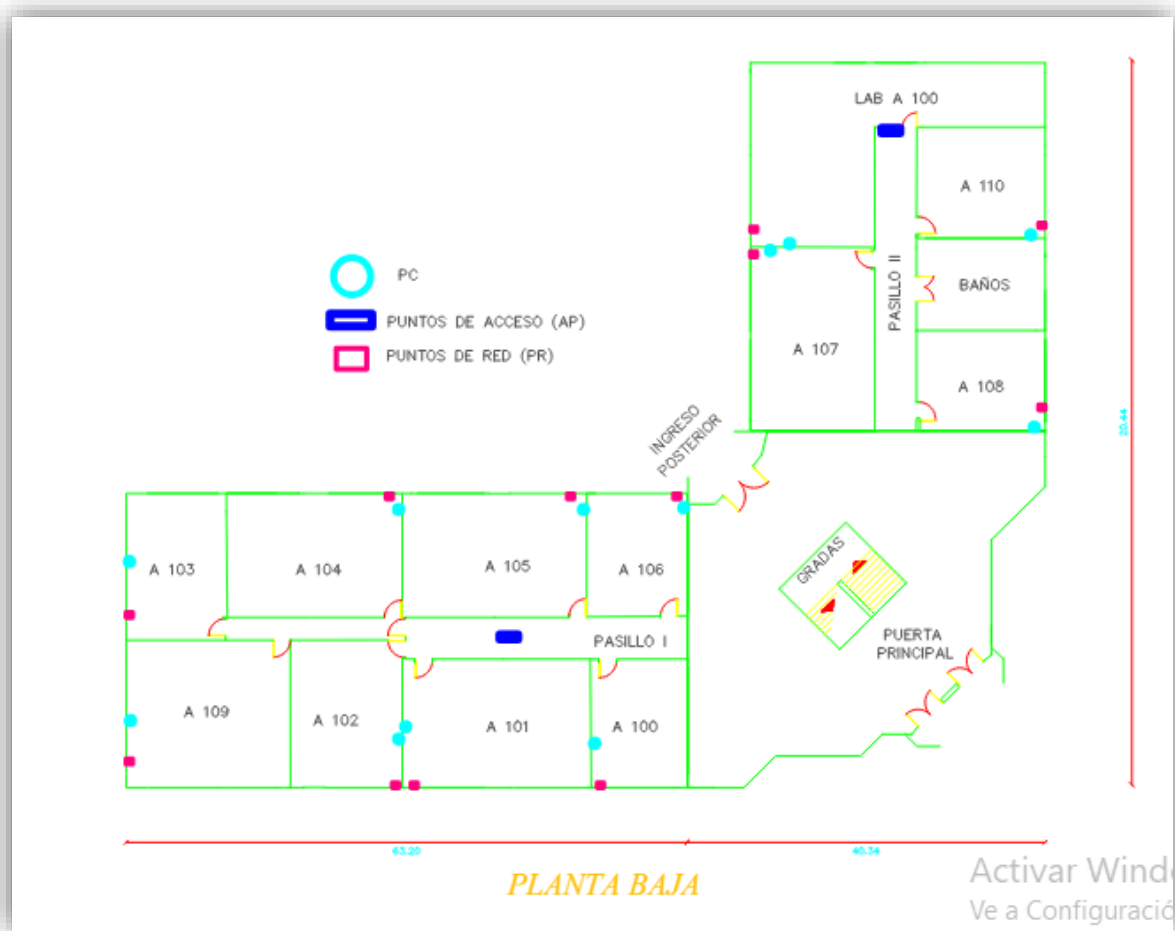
Planta Baja del Bloque A-Facultad de Ingeniería
